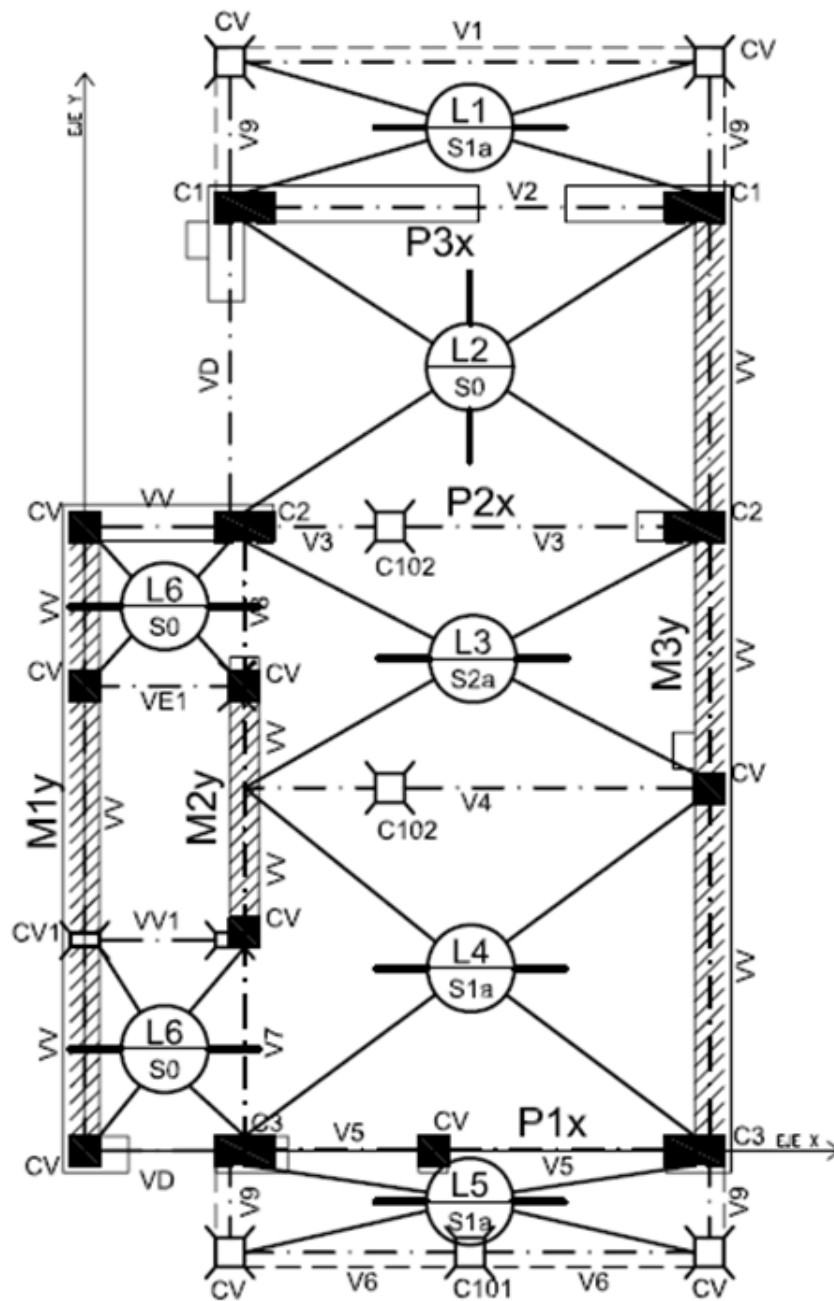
Planta de Estructura de planta baja de la vivienda de dos plantas.
